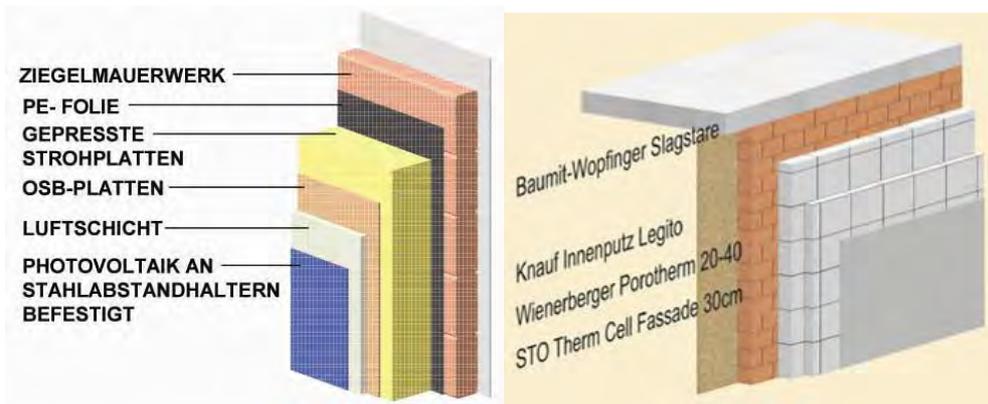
links: Wandaufbau Photovoltaikfassade (Dachgeschoss), rechts: Wandaufbau restliche gedämmte Außenwände (EG und OG) [www.sol4.info]
